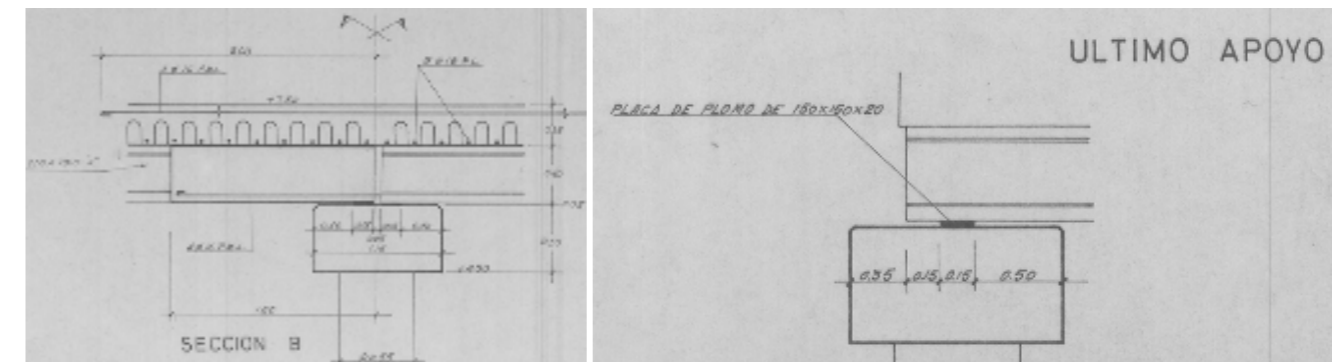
Detalle de vinculación vigas longitudinales - dintel - pilas
